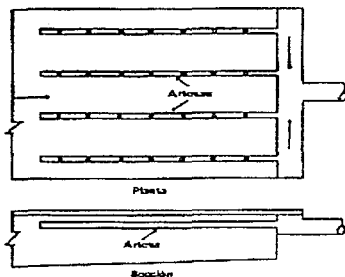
COLECTORES SUMERGIDOS CONSTITUIDOS DE PIPAS CON ORIFICIOS
